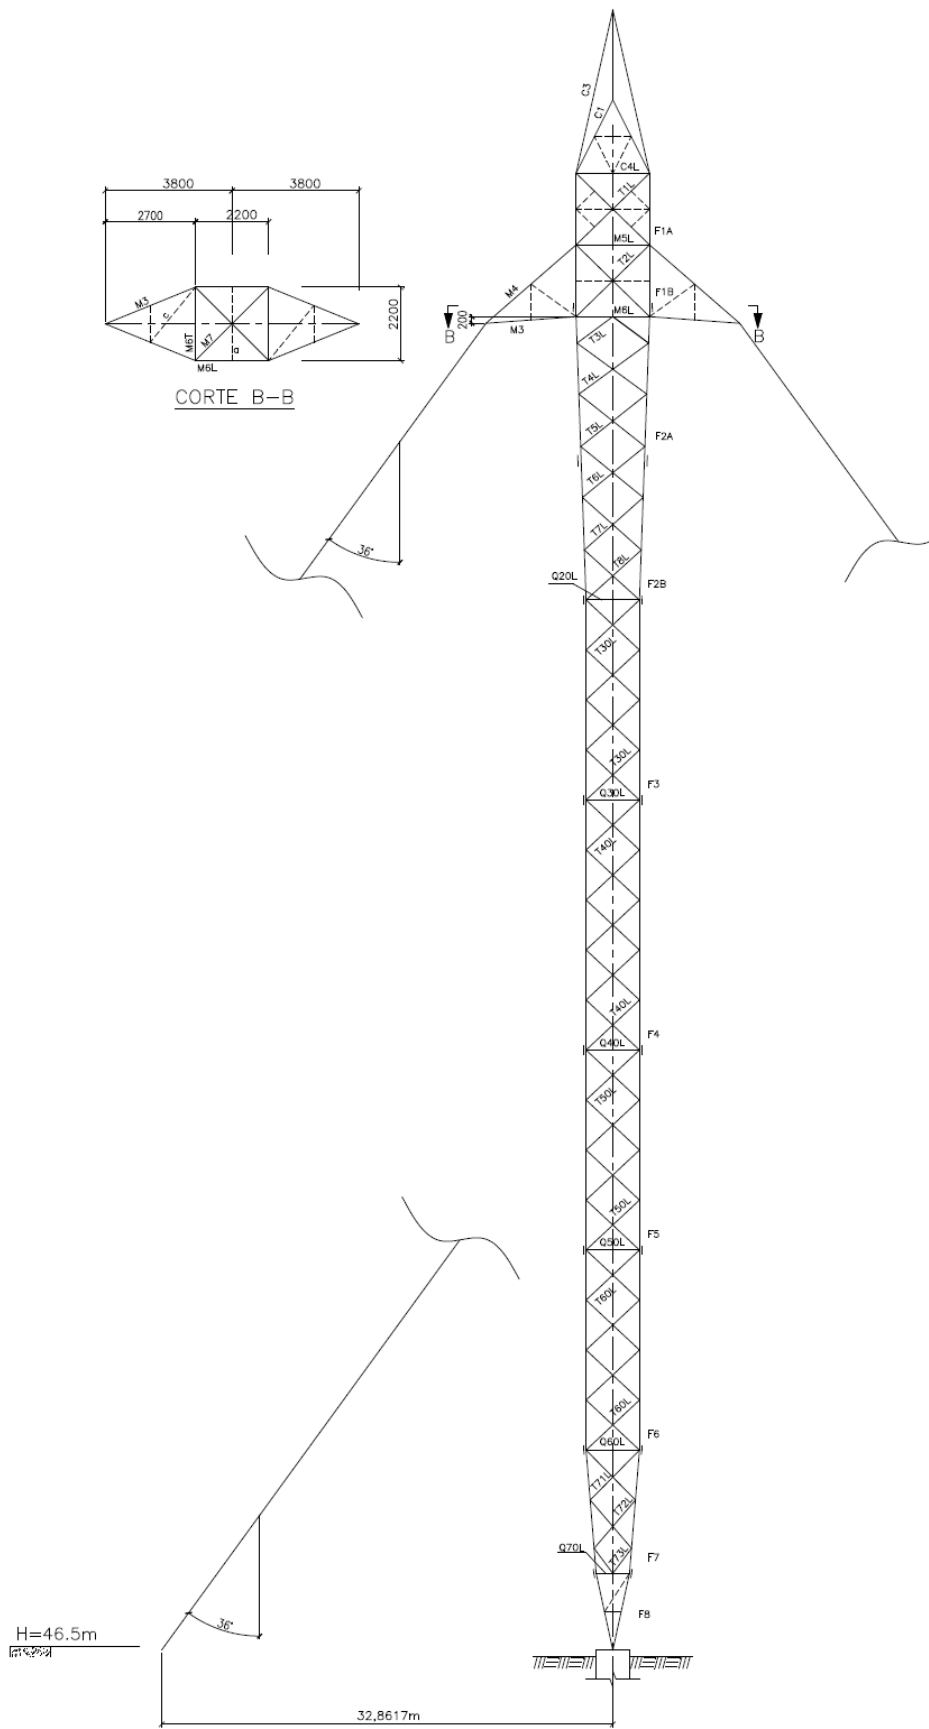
Vista longitudinal da torre estaiada monomastro
